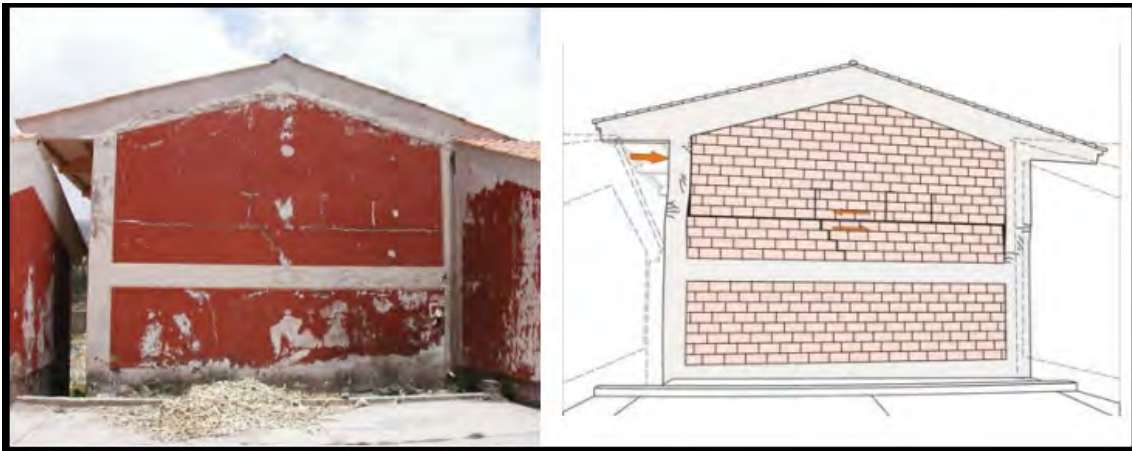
Falla por cizalle en la dirección transversal de un edificio escolar tipo 780 – Pre (izquierda) y esquema de acciones internas del muro transversal (derecha)
